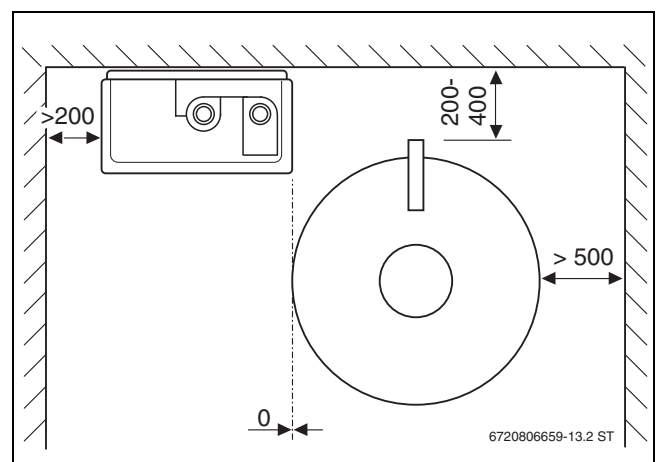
Ladesystem: Abstände bei Wandinstallation und Verwendung der Verbindungsleitungen (Zubehör), Darstellung mit Dämmungen, Maße in mm
